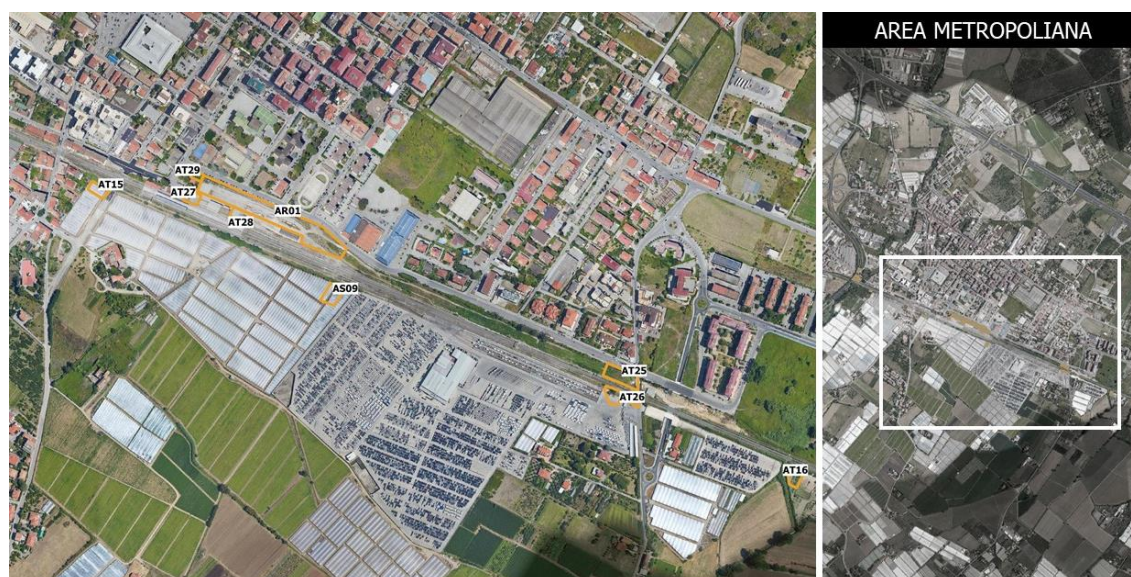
Dettaglio. Localizzazione delle aree di cantiere nell'area metropolitana a Pontecagnano
